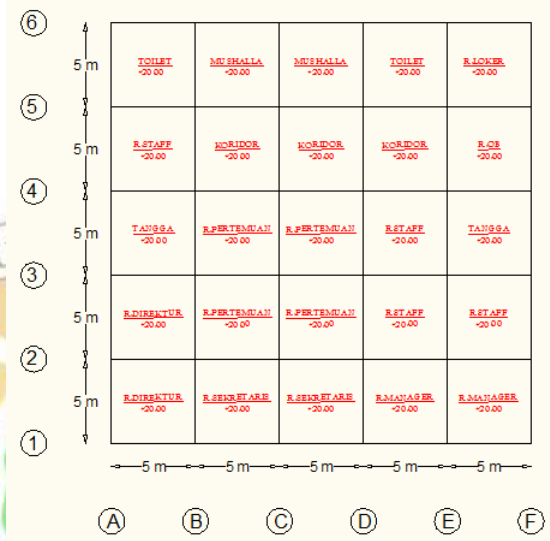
Layout Fungsi Ruang Lantai 2
